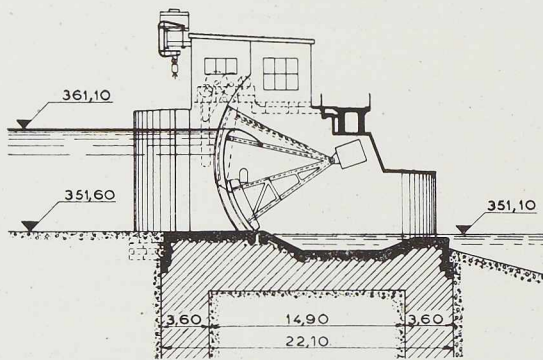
Coupe transversale du barrage de Rapperswil-Auenstein.
